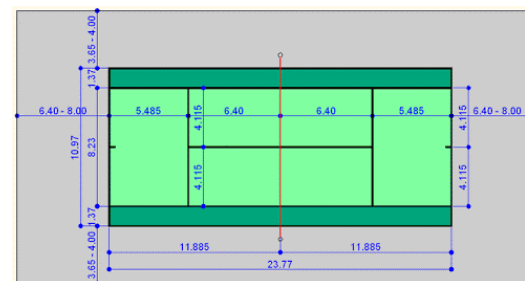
Dimensiones de la cancha de tenis. (Tenistas, 2020)
